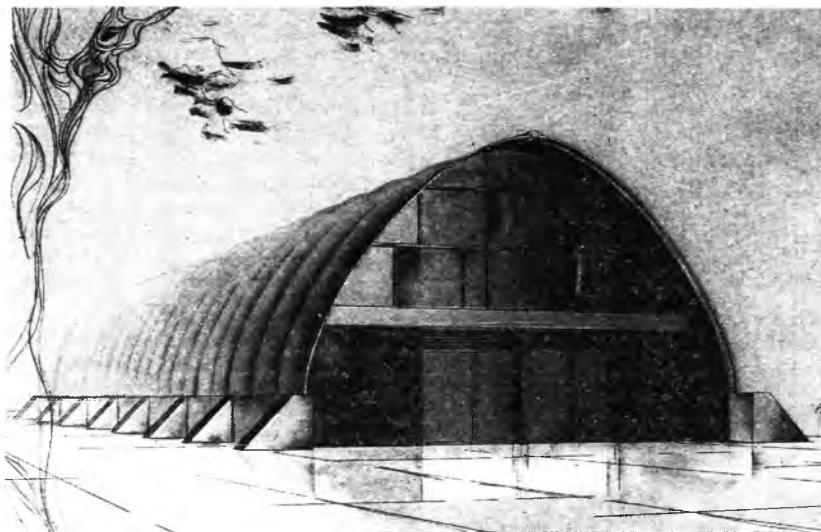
Универсальное сводчатое здание из армоцементных элементов
